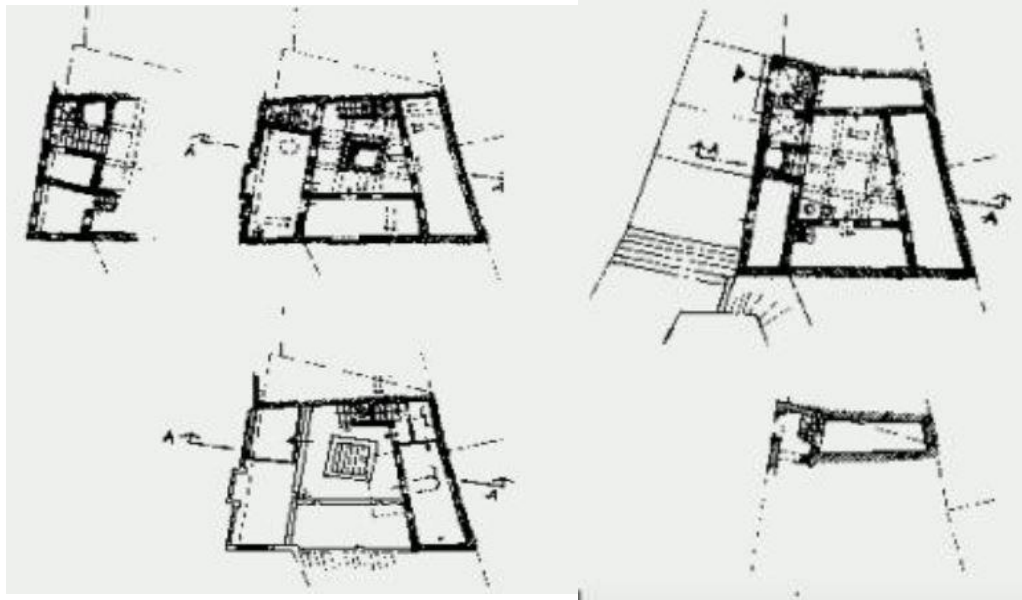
plantas la Kasbah de Argel-Marruecos.
